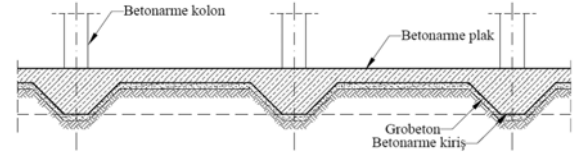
Düz kirişli plak temellerde döşeme oluşturulmasına ilişkin bir örnek
